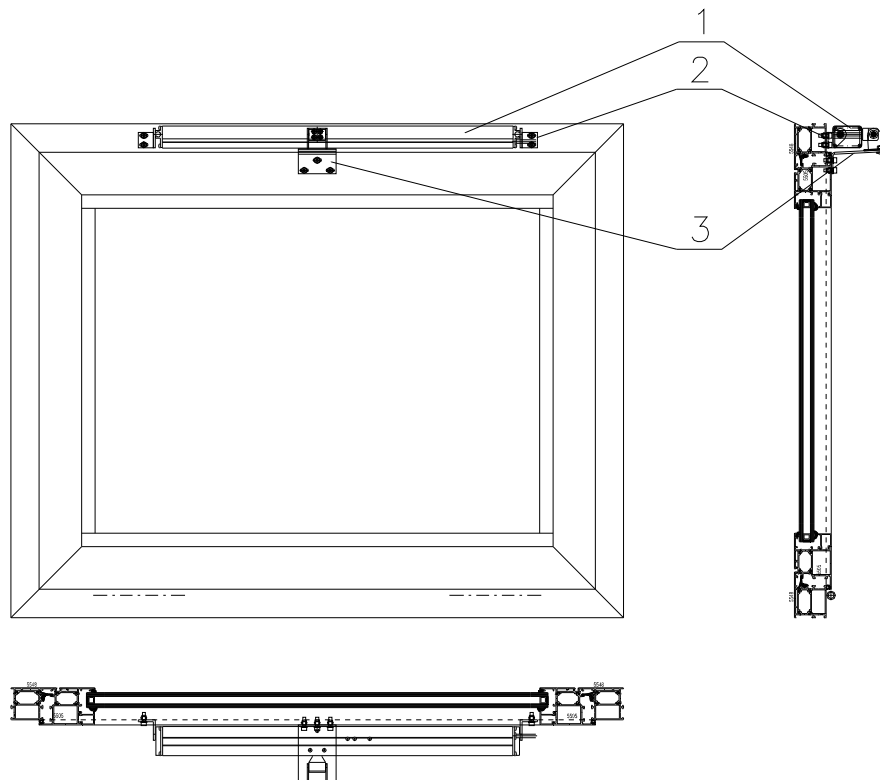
Inåtgående lucka med MCR-L KR10B spindelmotor (motorn monteras till karmen)
